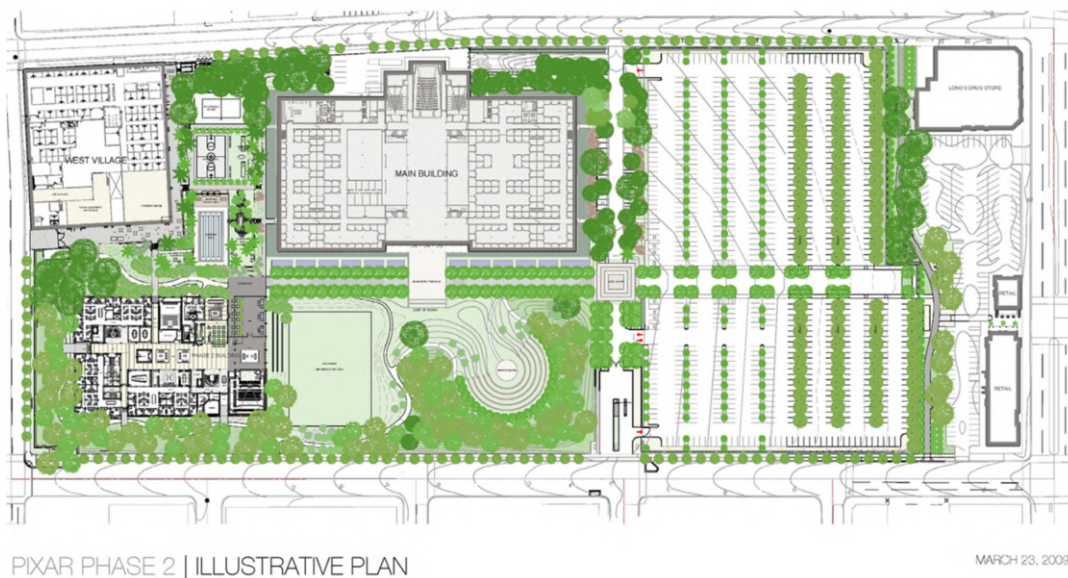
План першого поверху та середовища, будівля анімаційної студії Ріхар, США, арх. Bohlin Cywinski Jackson, 2000 [1]
